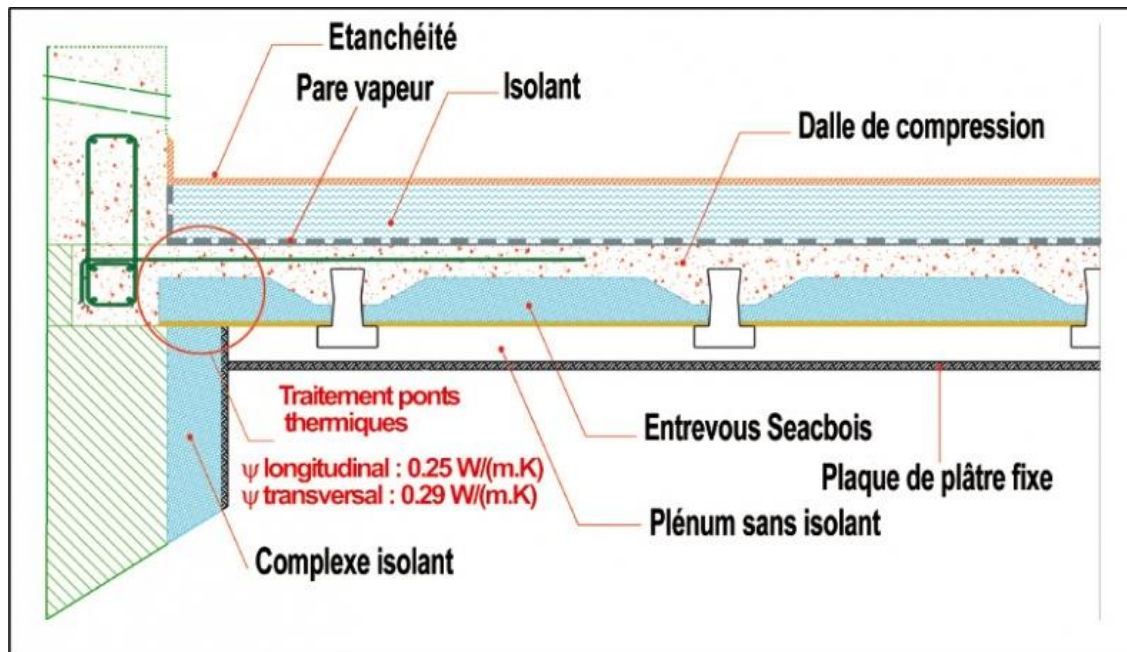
Détail fixation faux plafond. Source <http://kelisol.fr/isolation-du-toit/isoler-toiture-plate/>
